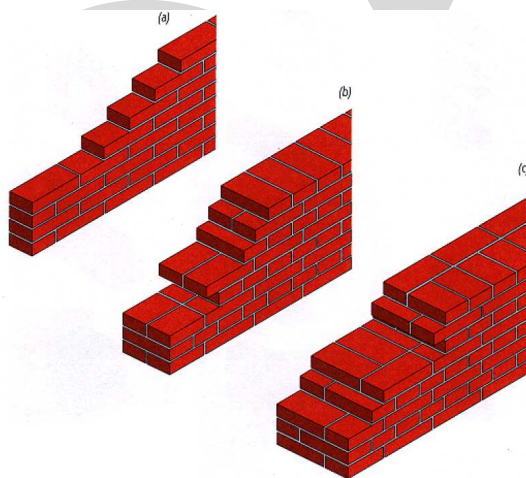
Murature ad a) una b) due e c) tre teste [6]
